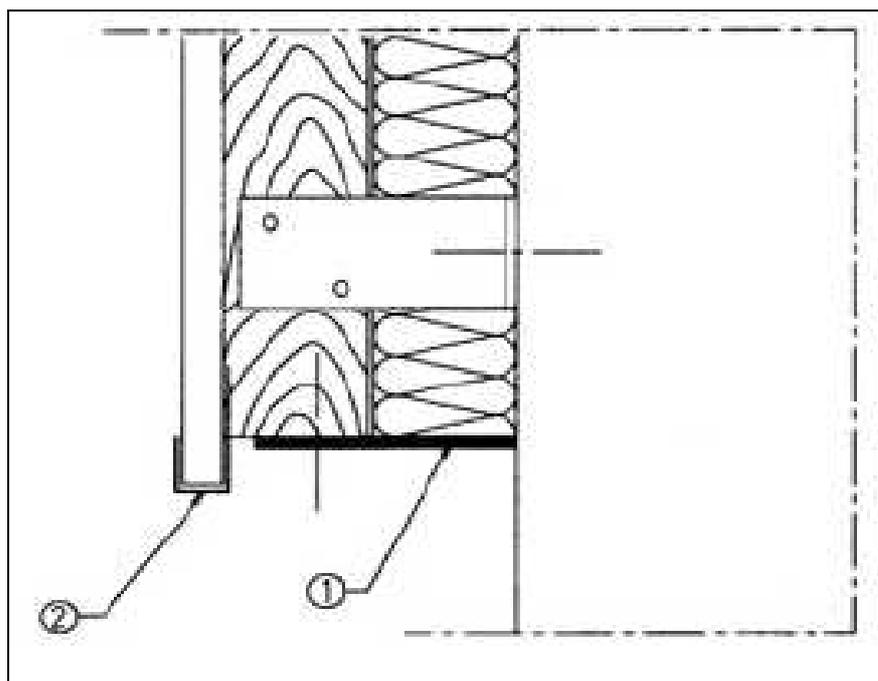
Solución en el encuentro del piso con el muro para un tipo de revestimiento exterior del tipo fachada ventilada.
